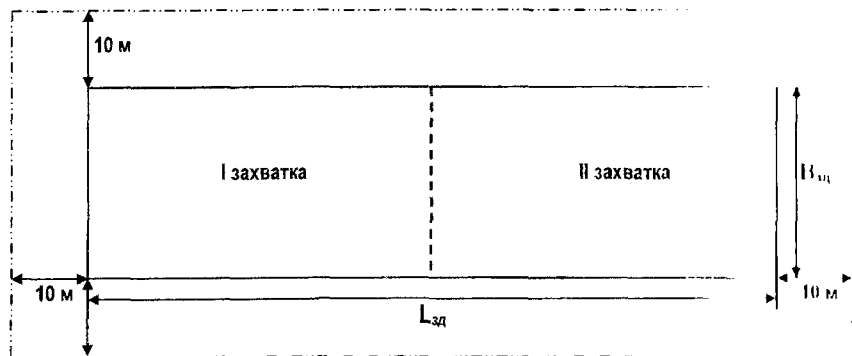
Схема срезки грунта при строительстве 2-х совмещенных секций
